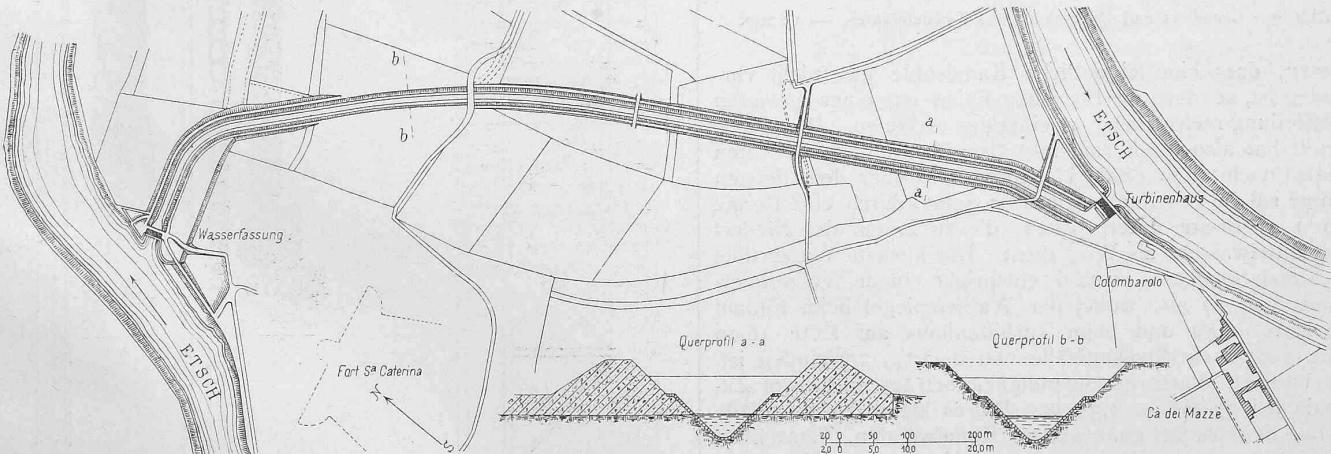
Lageplan der Anlage und Querprofile des Zulaufkanals. — Massstab 1:10000 für den Lageplan und 1:1000 für die Querprofile.
